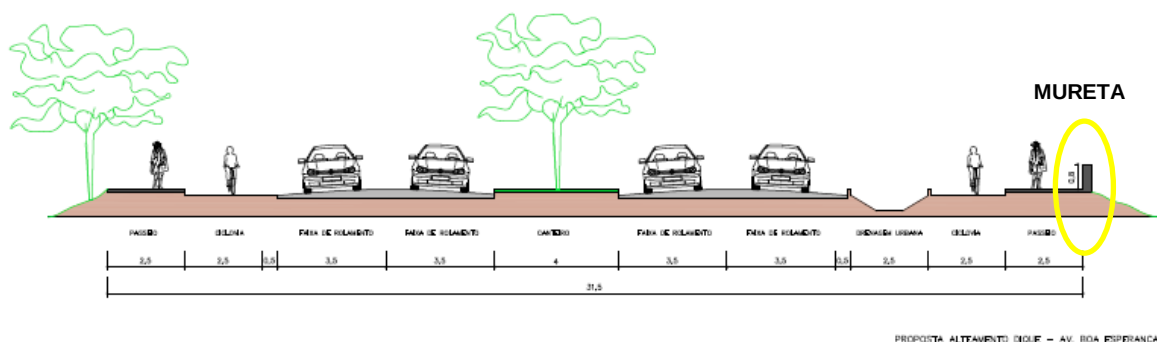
Projeto de mureta de concreto para adequação do nível de segurança hidráulica do projeto de duplicação da Avenida Boa Esperança.
